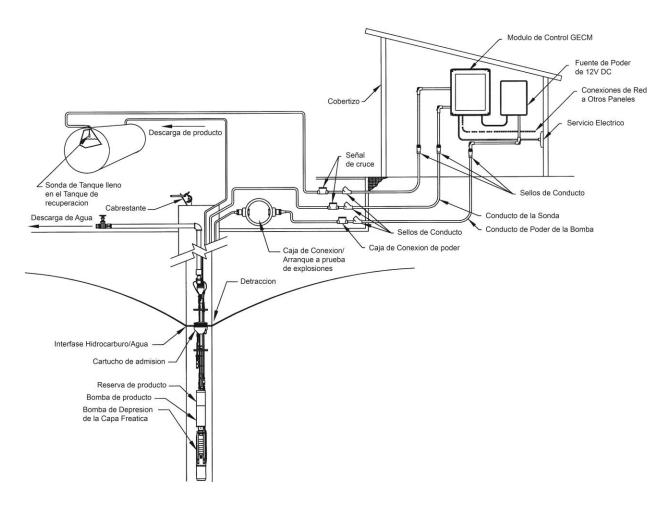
Una SDFS lista para WTDP desplegada con el GECM opcional, fuente de poder, Sonda de Tanque lleno y accesorios a prueba de explosión.
